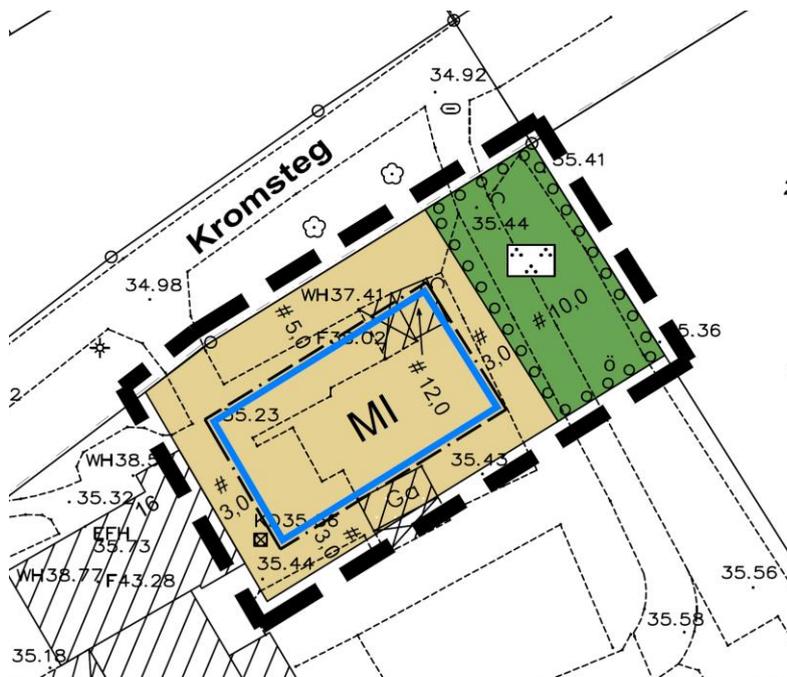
Ausschnitt Entwurf Bebauungsplan Nr. 33 -
